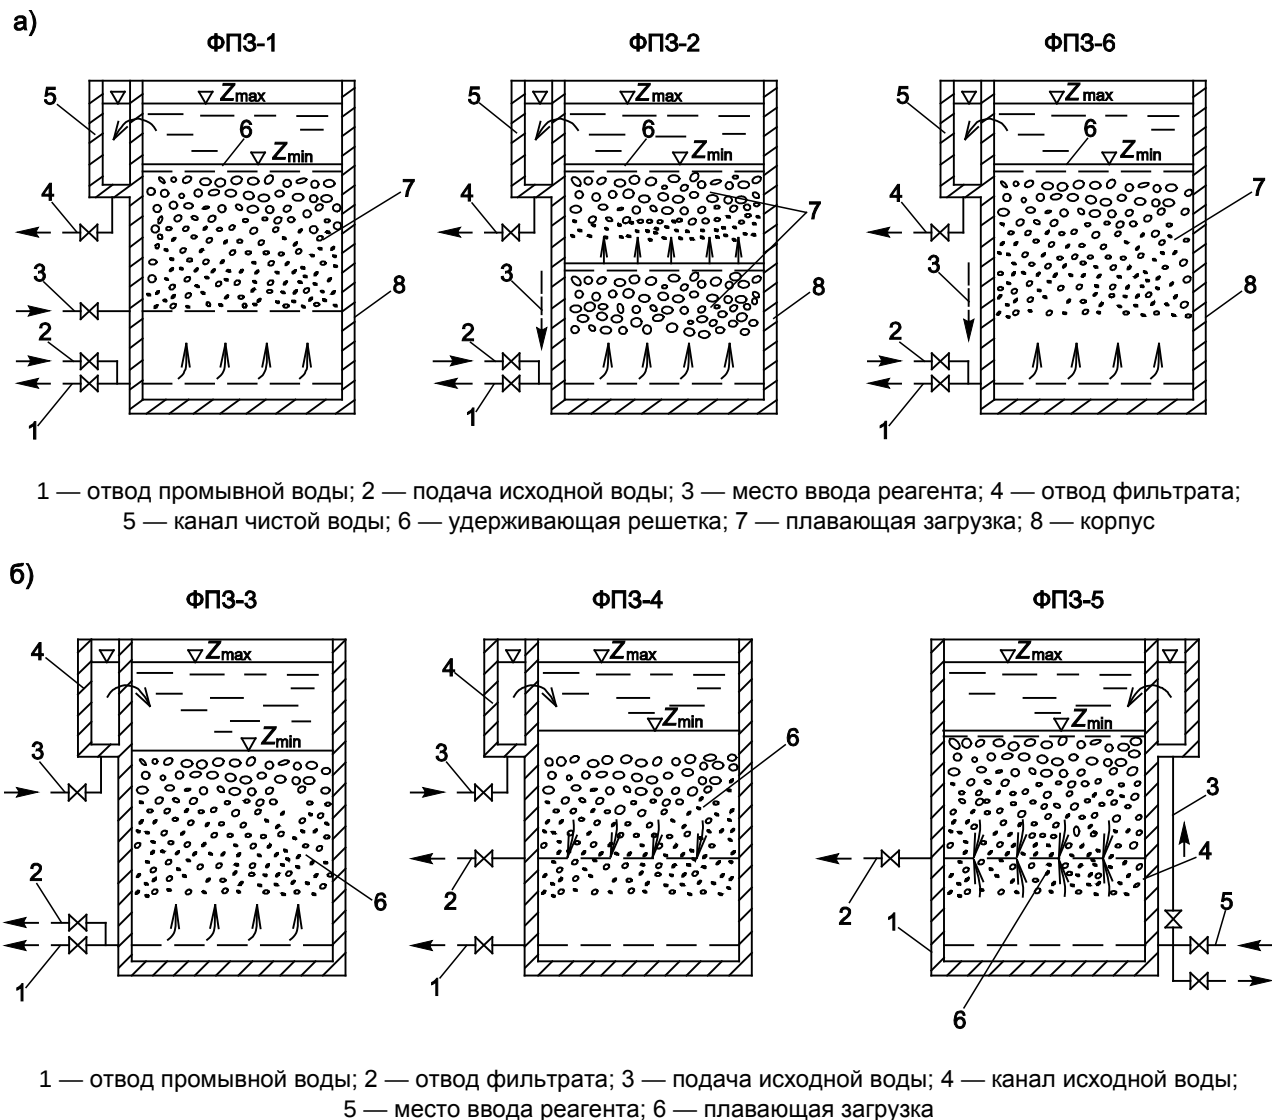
Конструктивные схемы фильтров с плавающей загрузкой (ФПЗ):
